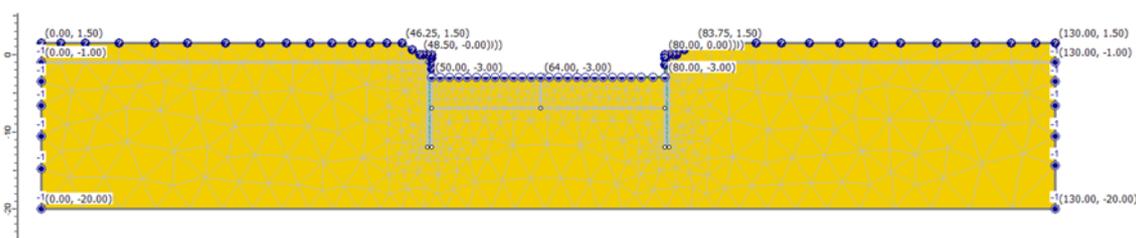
sezione del modello di calcolo nella fase di scavo "parziale" fino ad estradosso solettone di fondazione, prima dell'installazione del sistema well point
